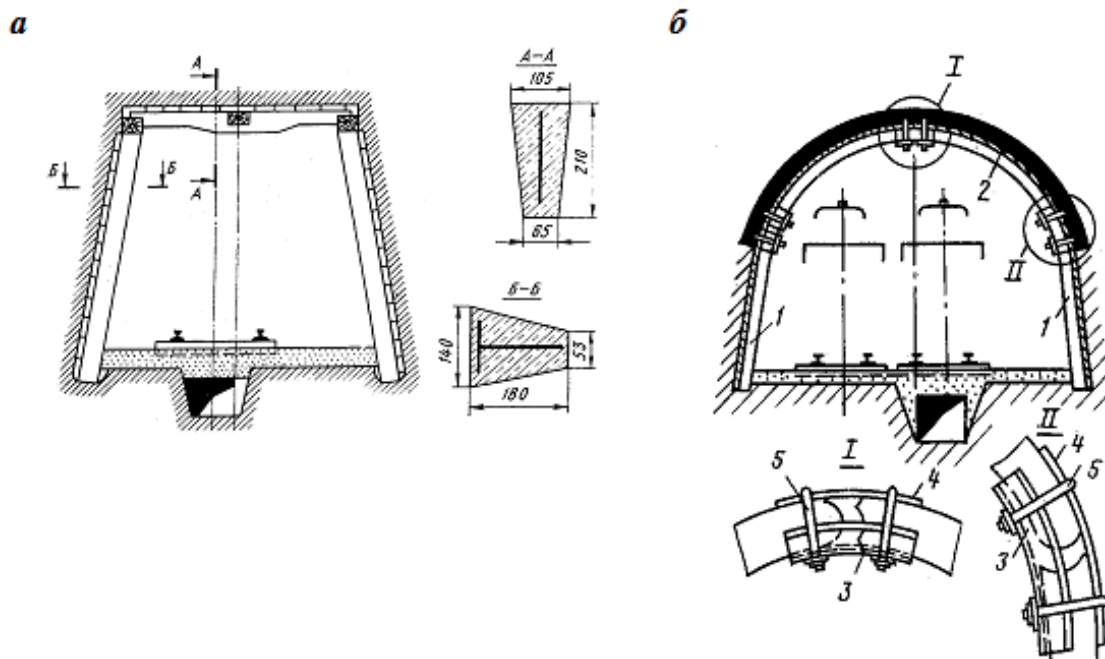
Сборные железобетонные рамные крепи: а — трапециевидная; б — арочная (1- стойки; 2 — криволинейные сегменты; 3 — отрезки спец.профиля; 4 — металлическая полоса; 5 — скобы с планками и гайками)
